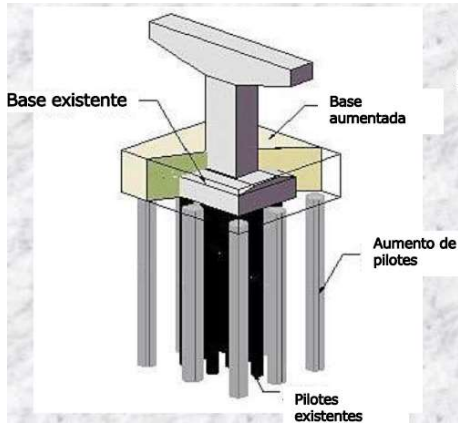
Estructuras para protección local en puentes, (CENAPRED, Instituto de ingeniería UNAM, 2017).
